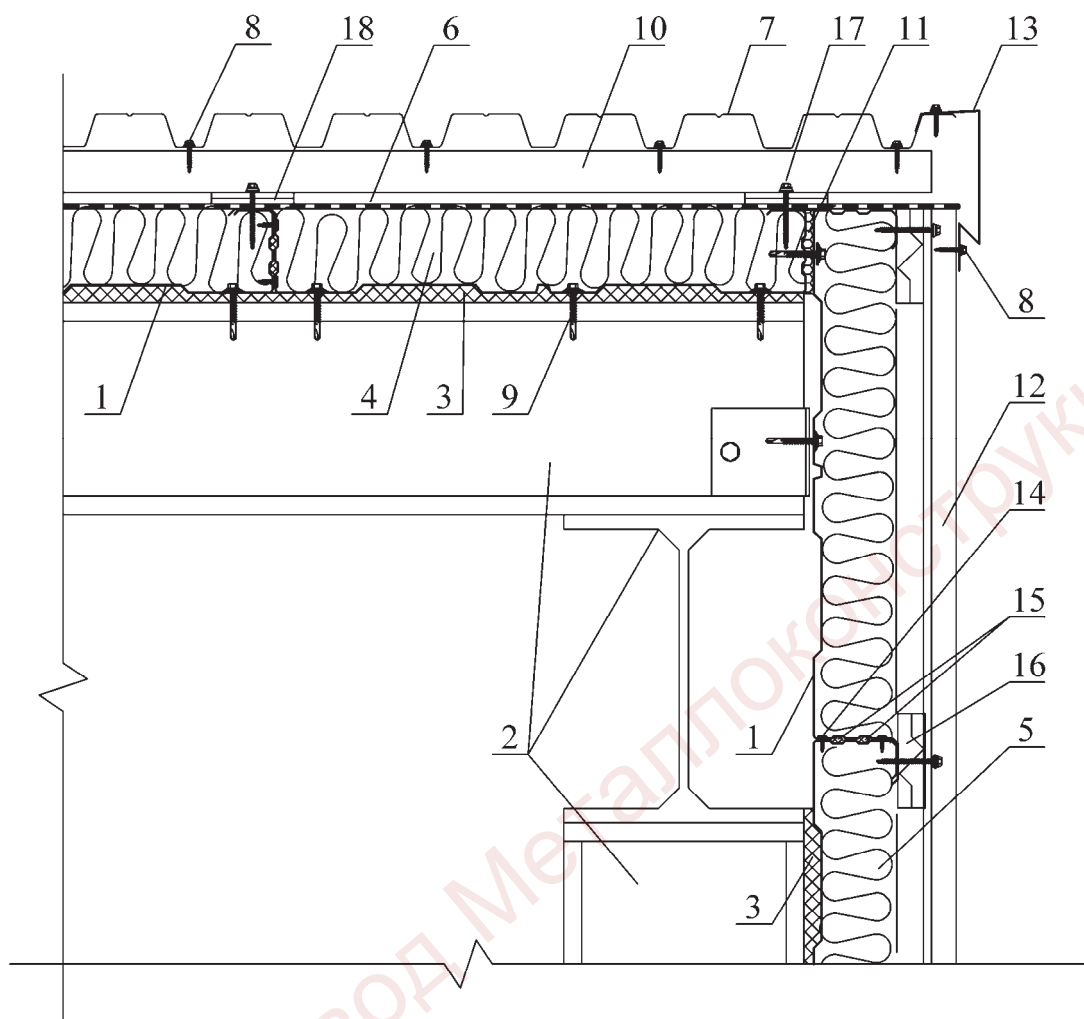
Узел сопряжения стены с кровлей (торец здания)
